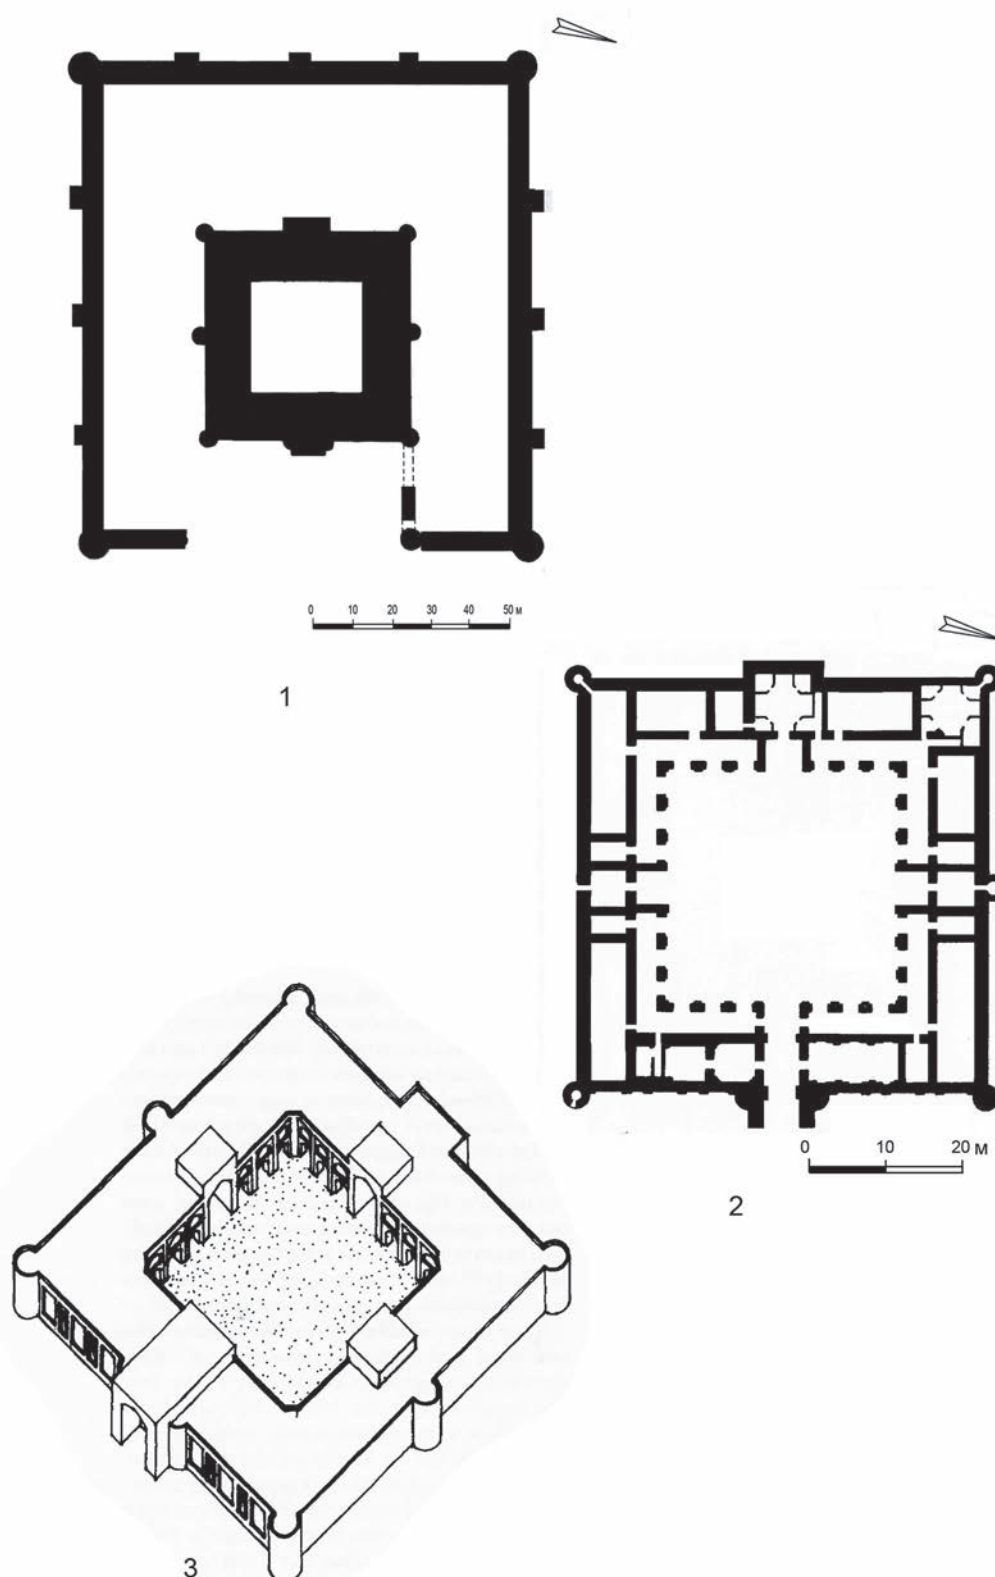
Дая-Хатын: 1 – план комплекса; 2 – план здания караван-сарая;
